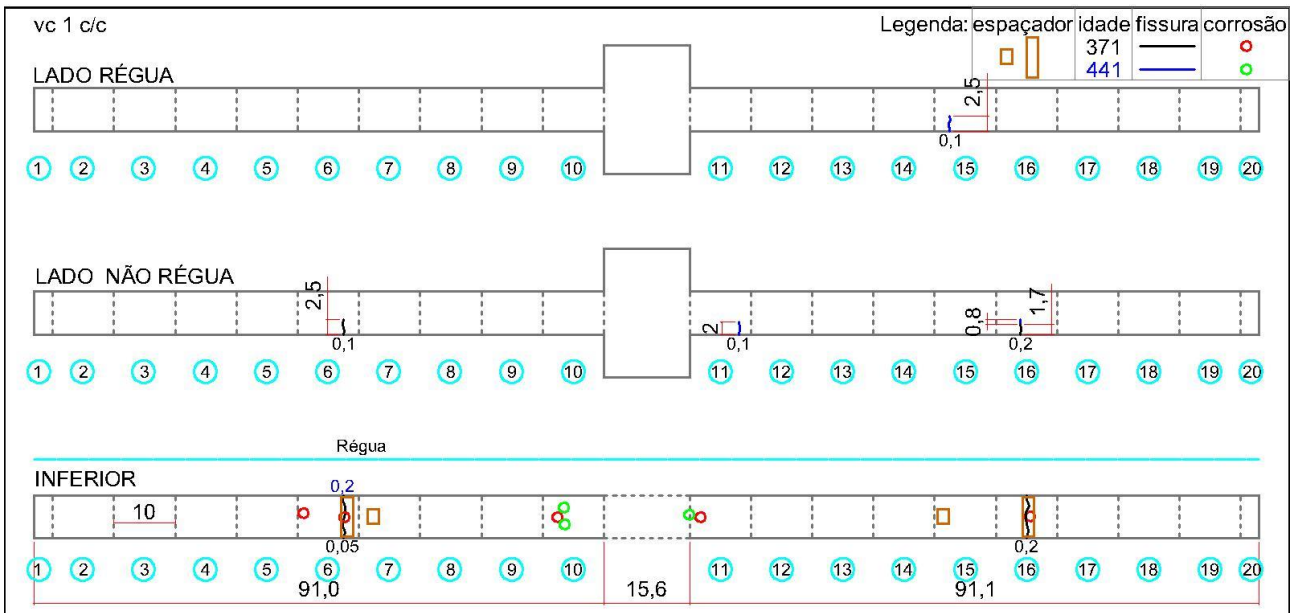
Mapa das fissuras na viga vc 1 c/c
